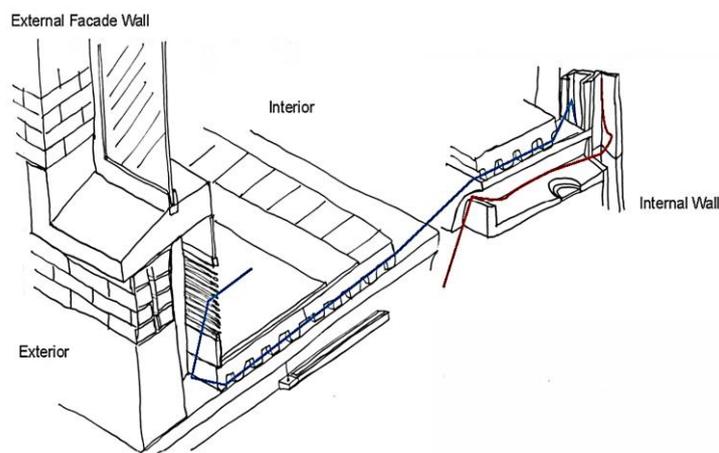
Dalle préfabriquée (droite) et plafond voûté en béton (gauche)
